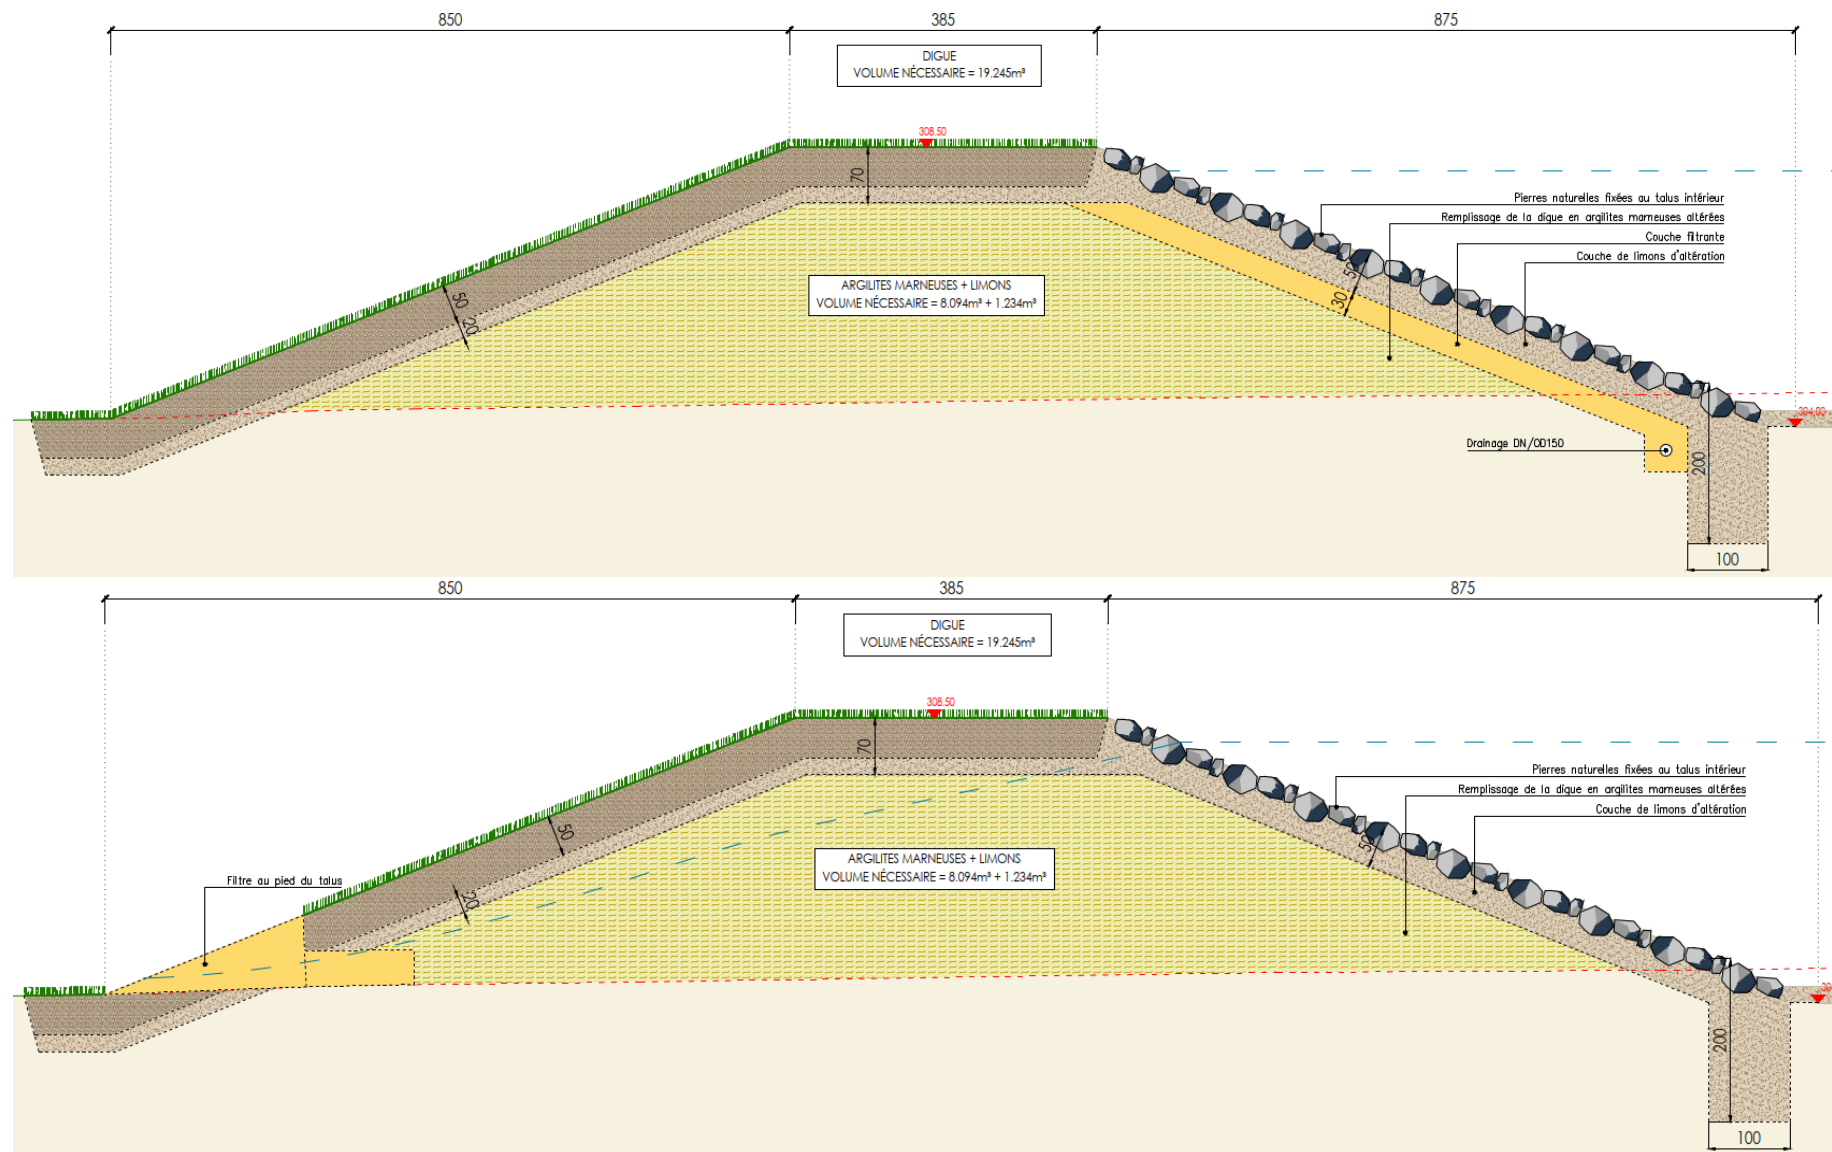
Querschnitte durch den Damm: Variante mit Drainageschicht an der Innenflanke (oben) und am äußeren Dammfuß (unten)(LUXPLAN S.A. 2022).
